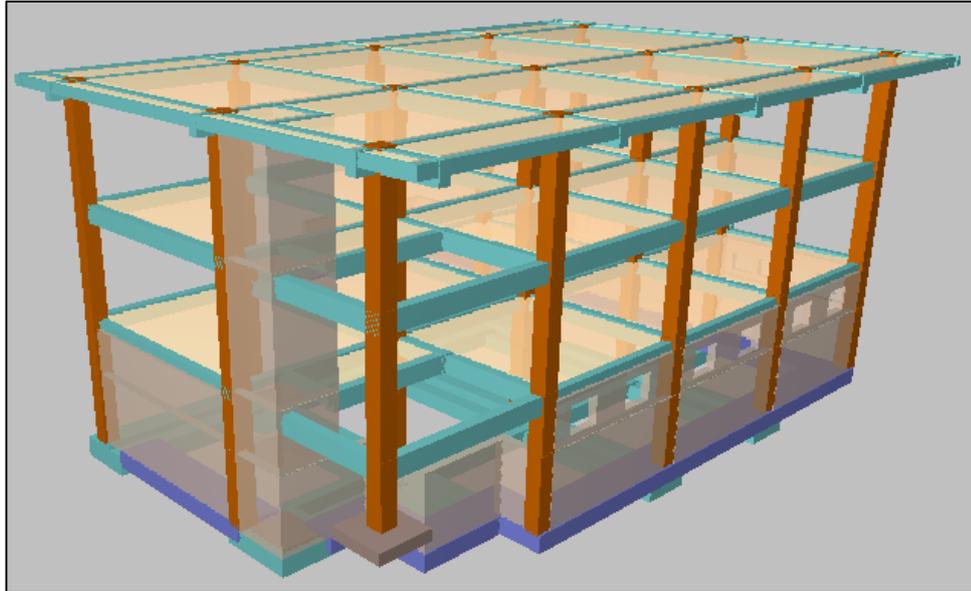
Modelo de la estructura en hormigón armado (lado izquierdo)
